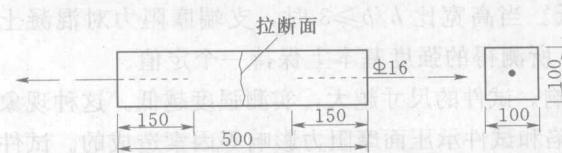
混凝土抗拉强度试验（尺寸单位：mm）
